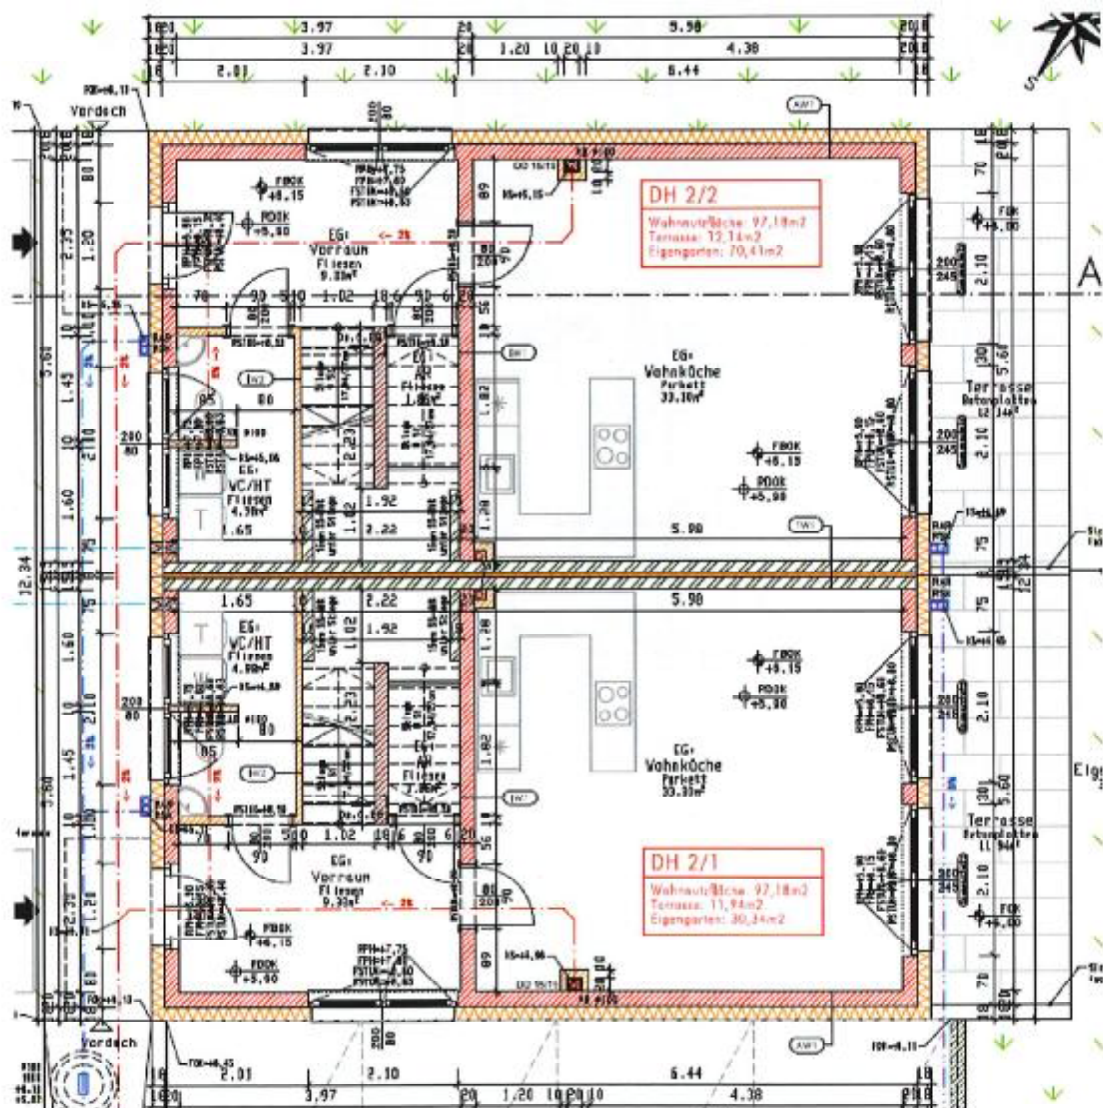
Grundriss Erdgeschoß | Doppelhaus 2 | 21.10.2021
